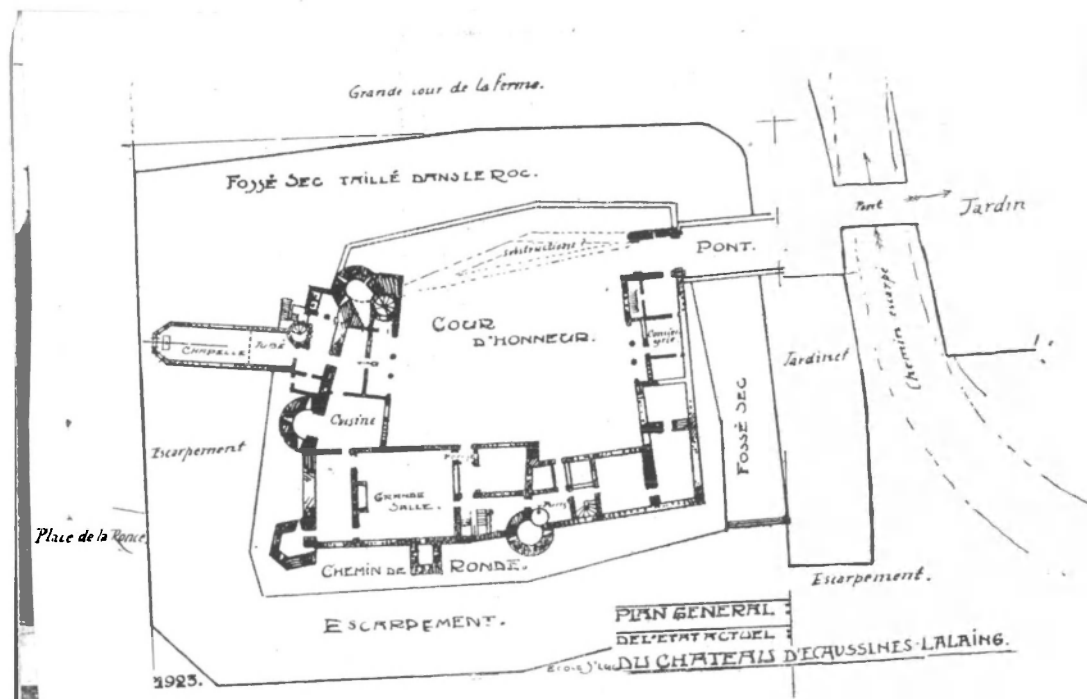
Fig. VII. — Plan du château d'Écaussinnes-Lalaing.
